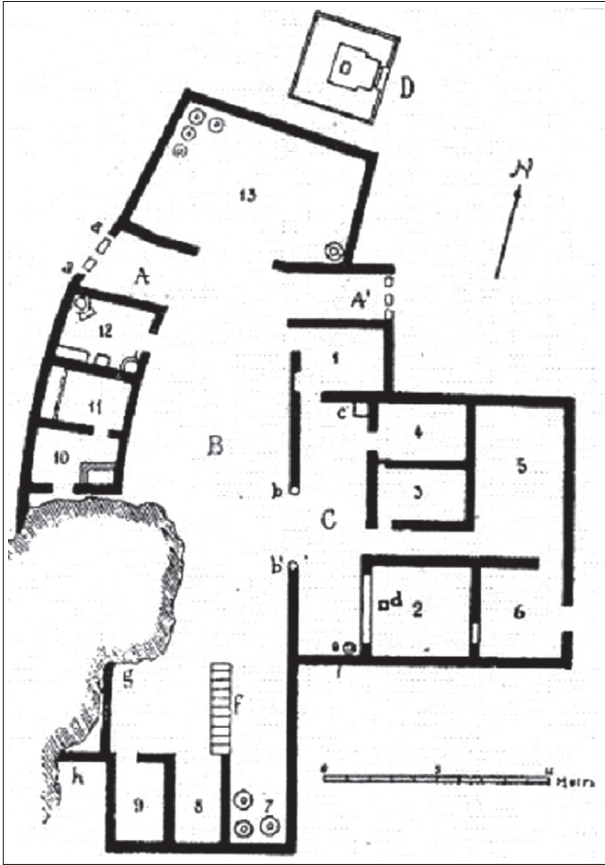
Villa del fondo Prisco: planimetria (da Stefani 2000).
